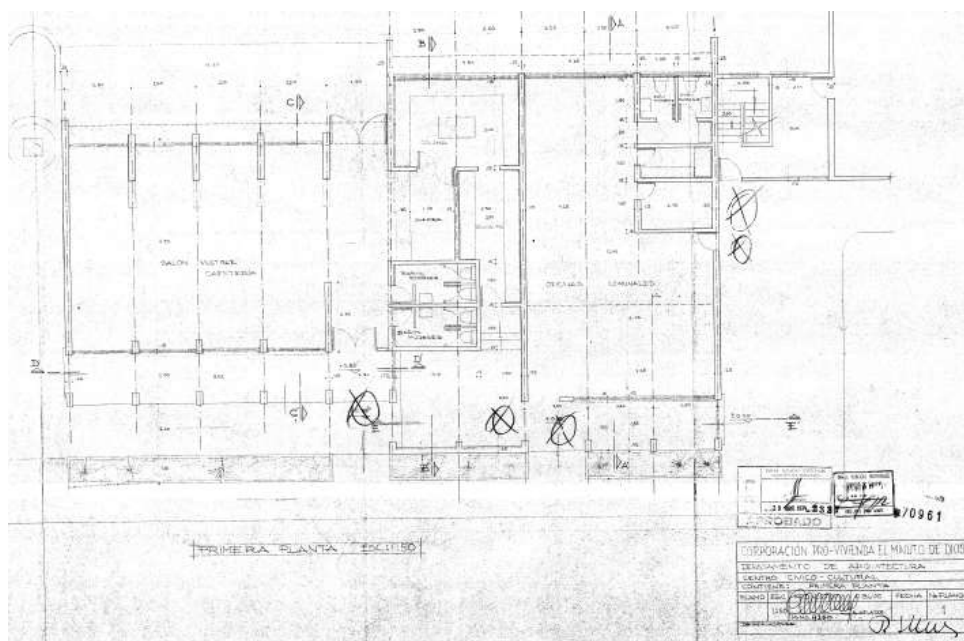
Planta de Primer Piso-Planos de Licencia de Construcción ON 2337
